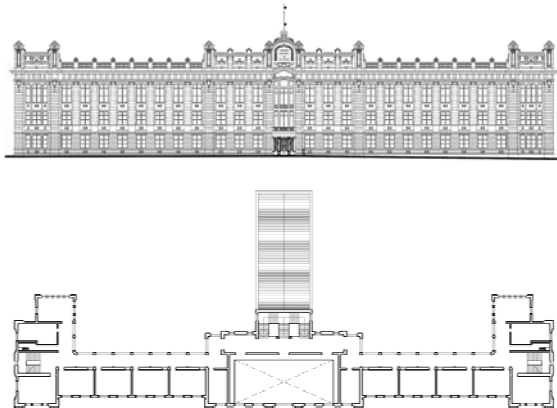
Edificio del Colegio Nacional. Planta y vista.
